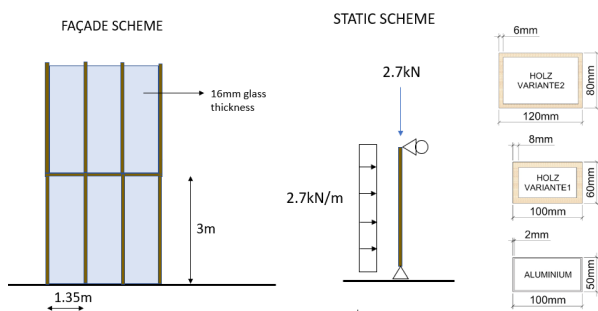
Schematische Darstellung von Fassadenaufbau, statischem System und Querschnitt der zu vergleichenden Hohlprofile
